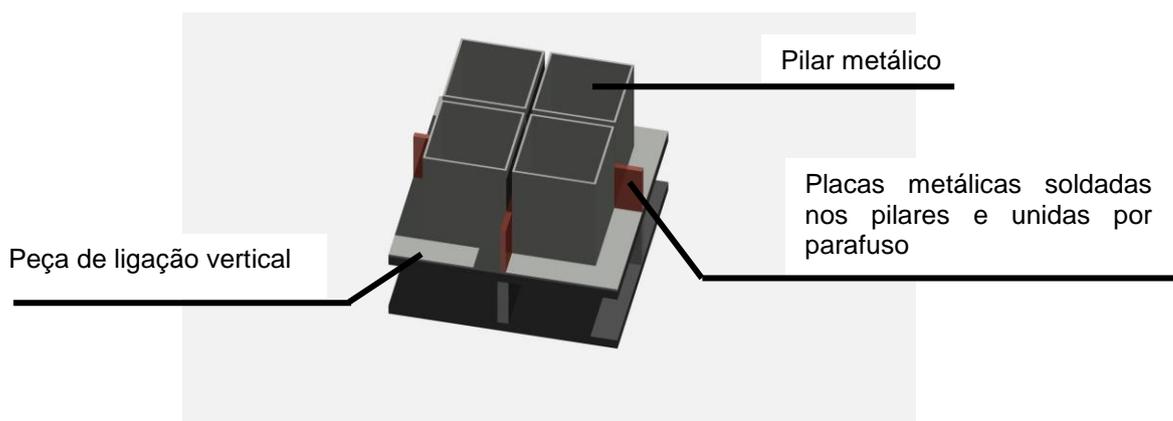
Detalhe das placas horizontais para quatro pilares
